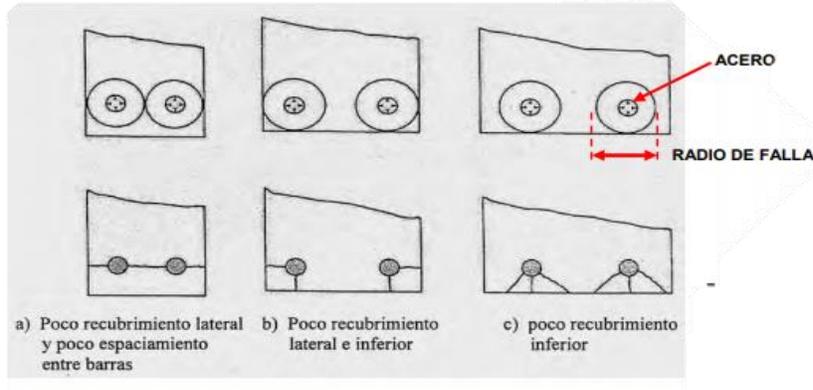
formas de falla en la sección transversal de una viga de concreto armado
